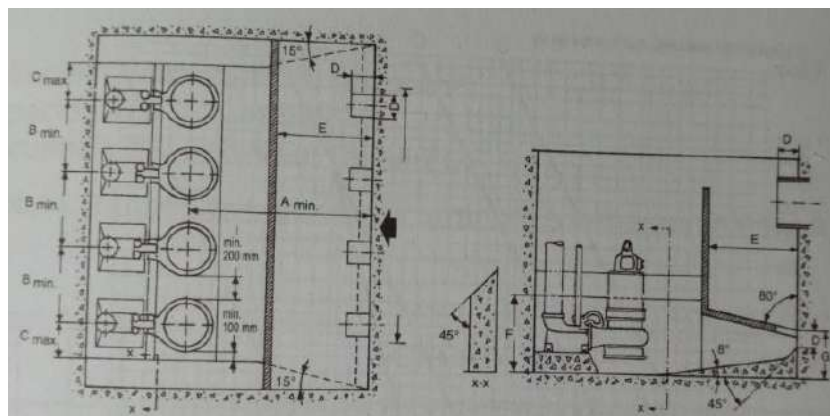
Pozo de bombeo.- Planta y alzado (Hernández et al., 2004)
